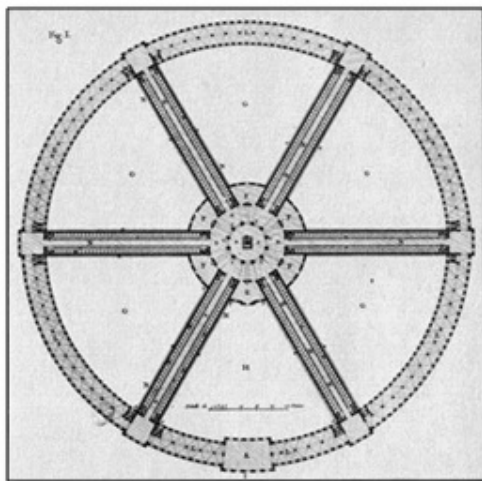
A. Petit, Planta Hôtel-Dieu, Paris, 1774
